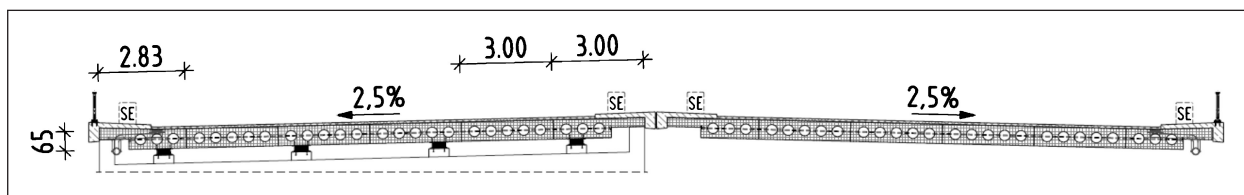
Spannbetonplatte mit einbetonierten Rohren
